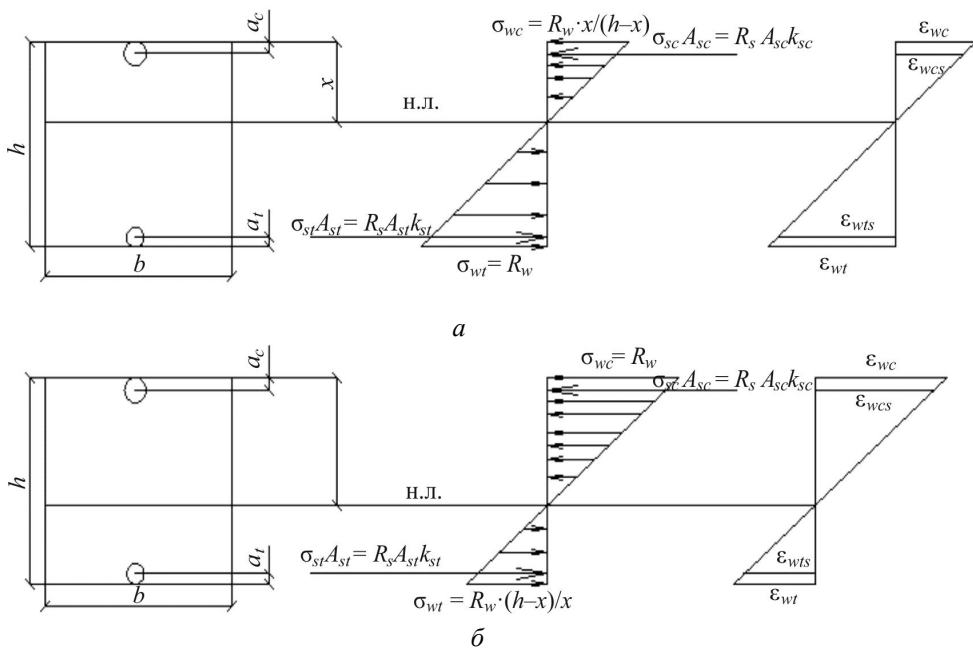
Схема к расчету деревянной балки с двойным армированием: а – при достижении расчетного сопротивления в растянутых волокнах балки; б – при достижении расчетного сопротивления в сжатых волокнах балки; h – высота сечения балки, см; b – ширина сечения балки, см; x – высота сжатой зоны, см; a_t и a_c – глубина заделки арматуры растянутой и сжатой зон балки соответственно, см; σ_{st} и σ_{sc} – напряжения в растянутой и сжатой арматуре соответственно, кг/см²; σ_{wt} и σ_{wc} – напряжения в крайних растянутых и крайних сжатых волокнах древесины, кг/см²; R_s и R_w – расчетное сопротивление изгибу арматуры и древесины соответственно, кг/см²; A_{st} и A_{sc} – площадь поперечного сечения растянутой и сжатой арматуры, см²; ε_{wt} и ε_{wc} – предельная относительная деформация древесины растянутой и сжатой зоны соответственно; ε_{wts} и ε_{wcs} – относительная деформация растянутой и сжатой арматуры соответственно
